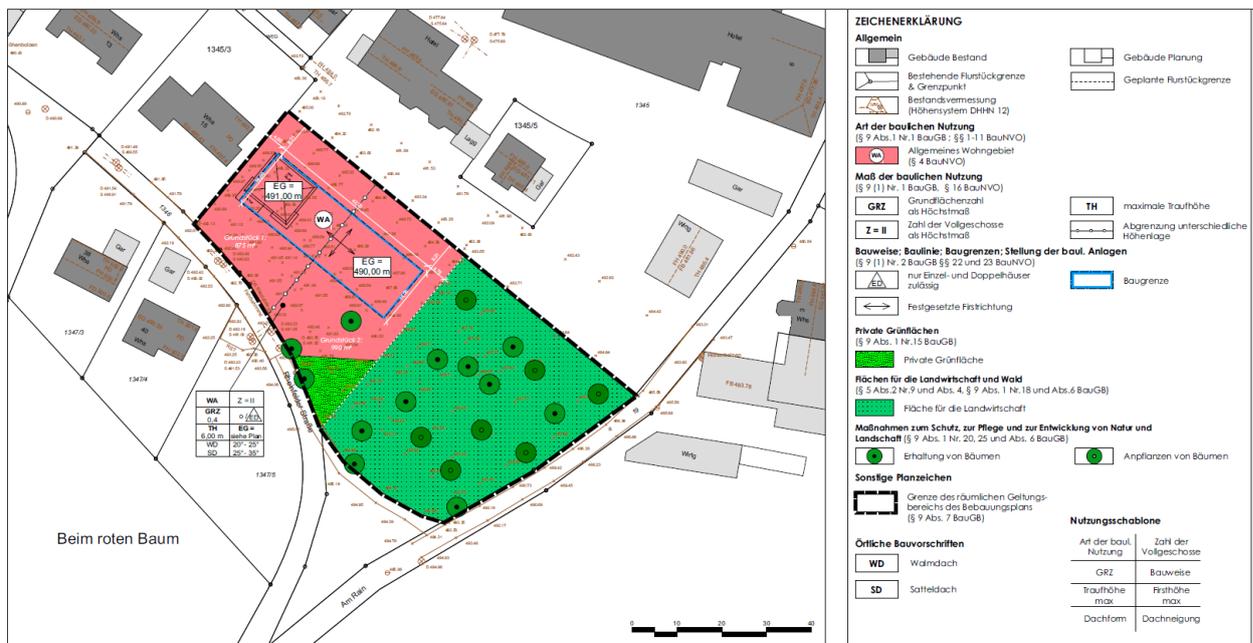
Bebauungsplan „Östliche Hühnerhalden – Am Rain“ (Quelle: Stadtbau Lörrach, Stand 15.03.2022)
